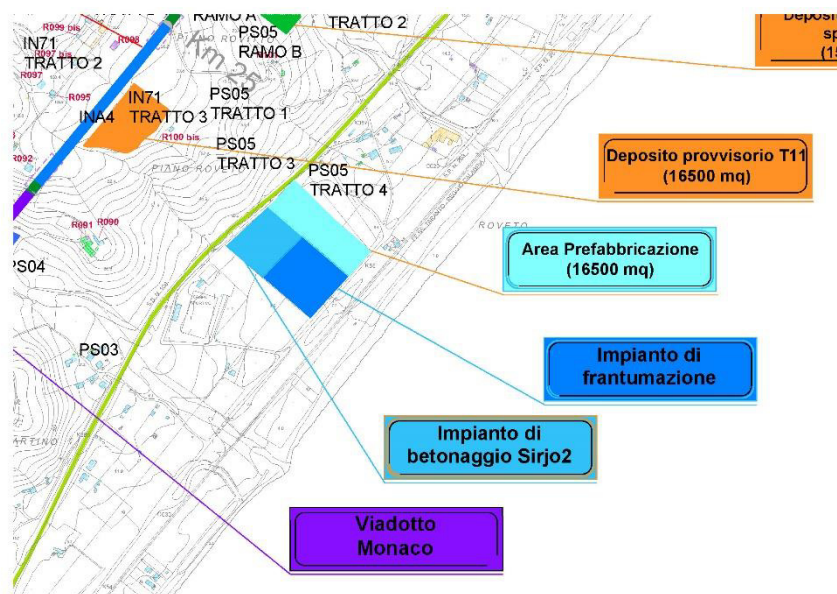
Inquadramento territoriale dell'area di prefabbricazione, dell'impianto di frantumazione e dell'impianto di betonaggio Sirjo2. Inquadramento territoriale dell'area di deposito provvisorio T11.
